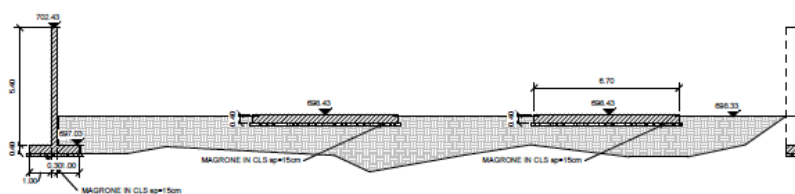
Sviluppo longitudinale e sezione trasversale dei muri paraschegge- Stazione di Edolo (BS)
